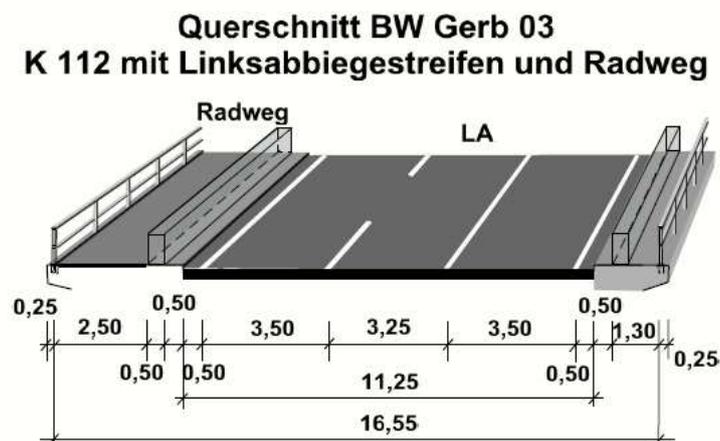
Querschnitt Bauwerk Gerb 03 - Kreisstraße 112
